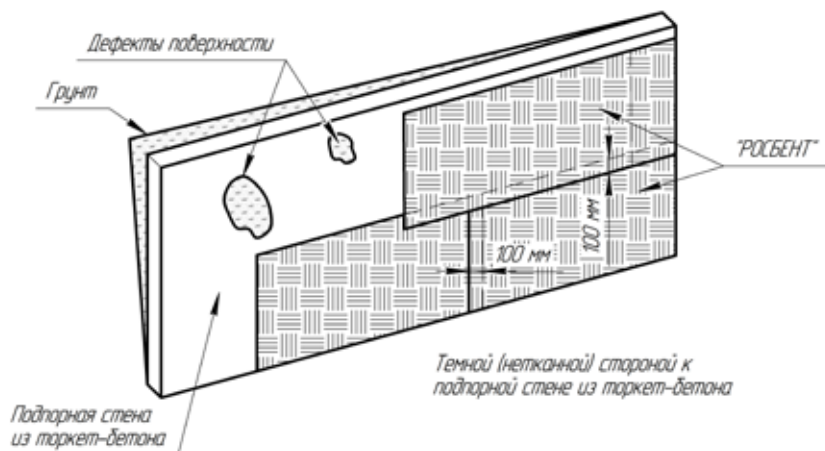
Укладка «Росбент» на вертикальную поверхность подпорной стены из торкретбетона
